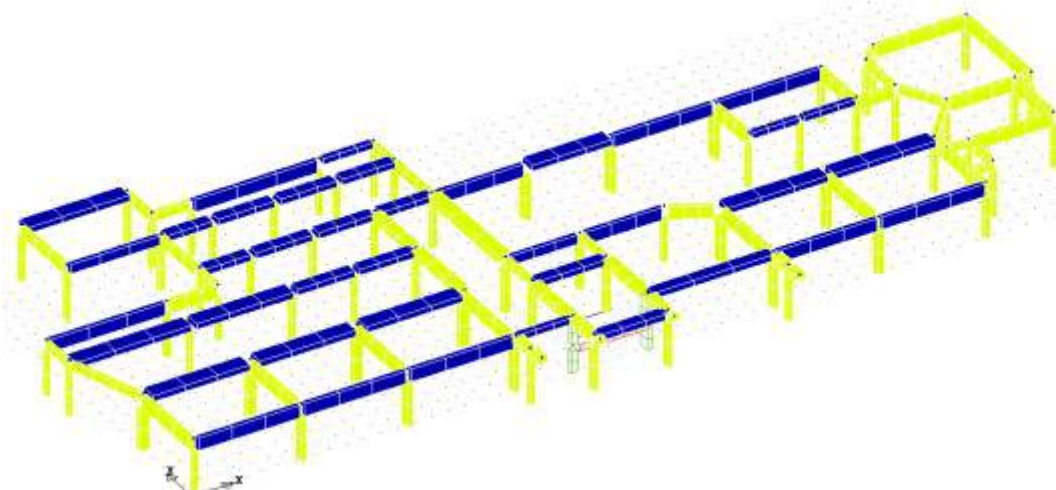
Elementi strutturali oggetto di rinforzo al piano terra (in giallo)
